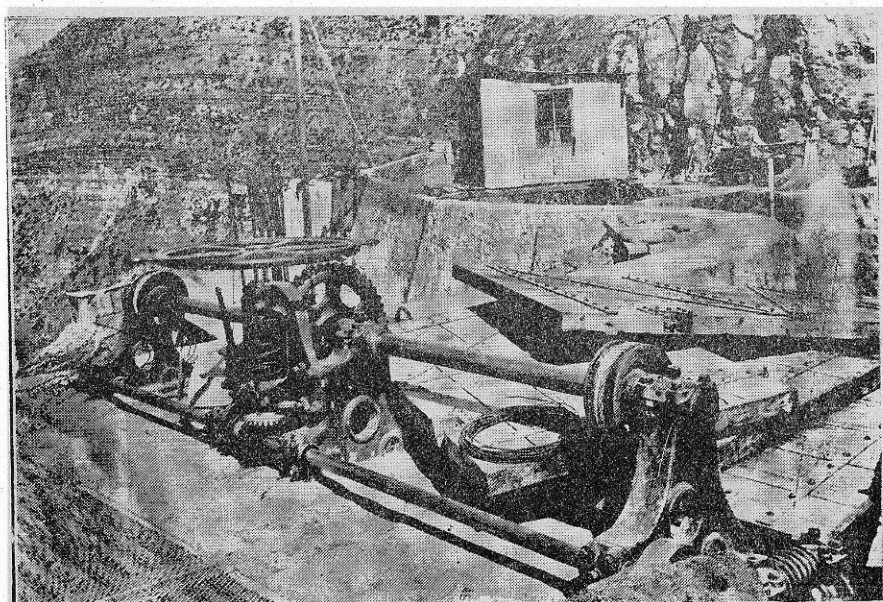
Cámara de Carga, Aparato elevador de las compuertas "Taintor"
